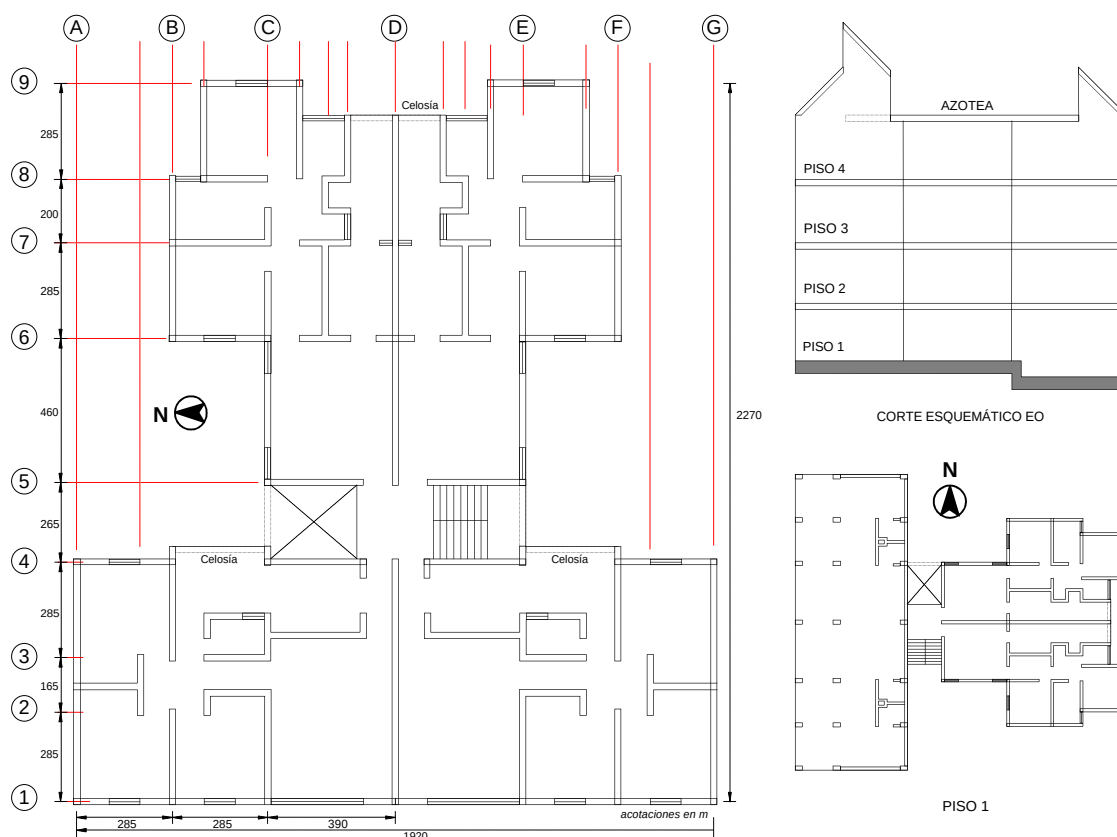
Planta tipo con dimensiones, corte y esquema del primer nivel
